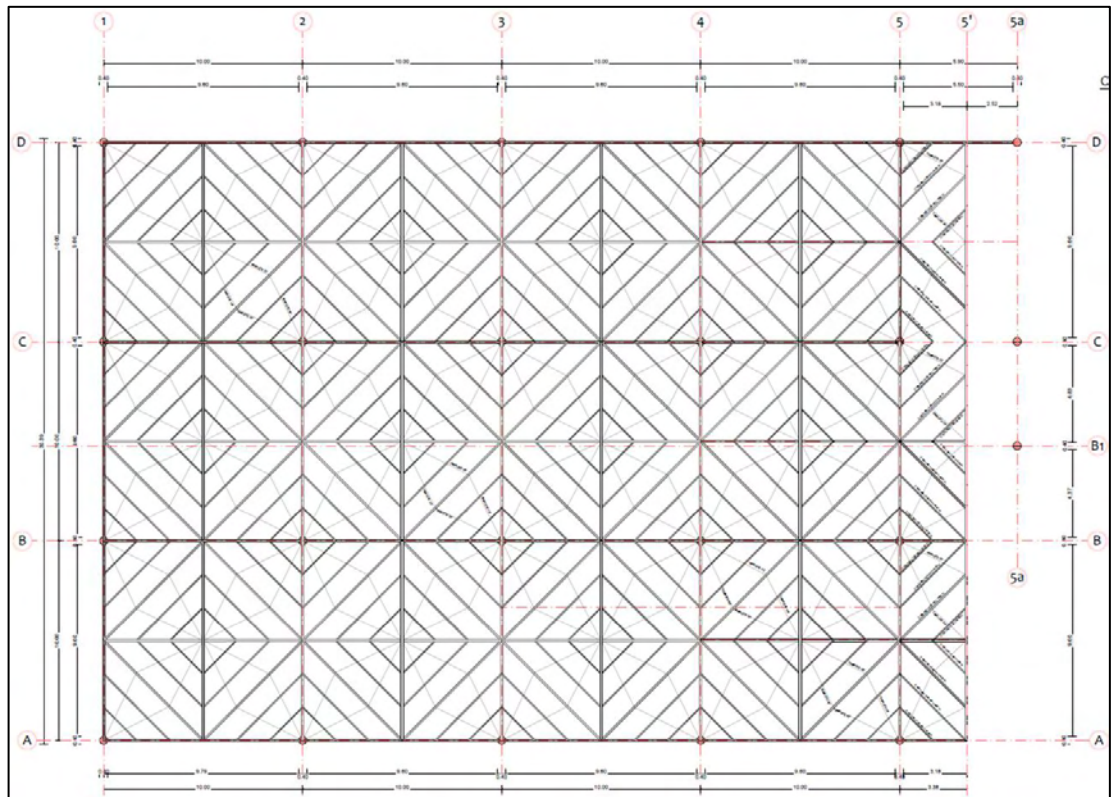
Planta de estructura de cubierta modificada Zona A
